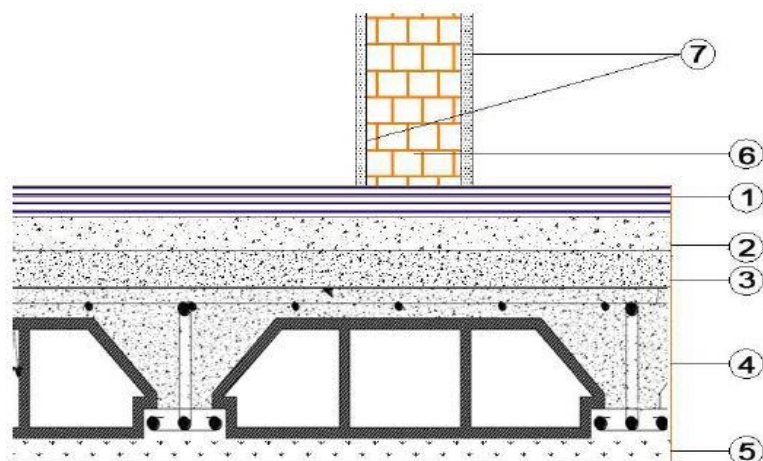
Coupe verticale du dernier plancher (terrasse).
